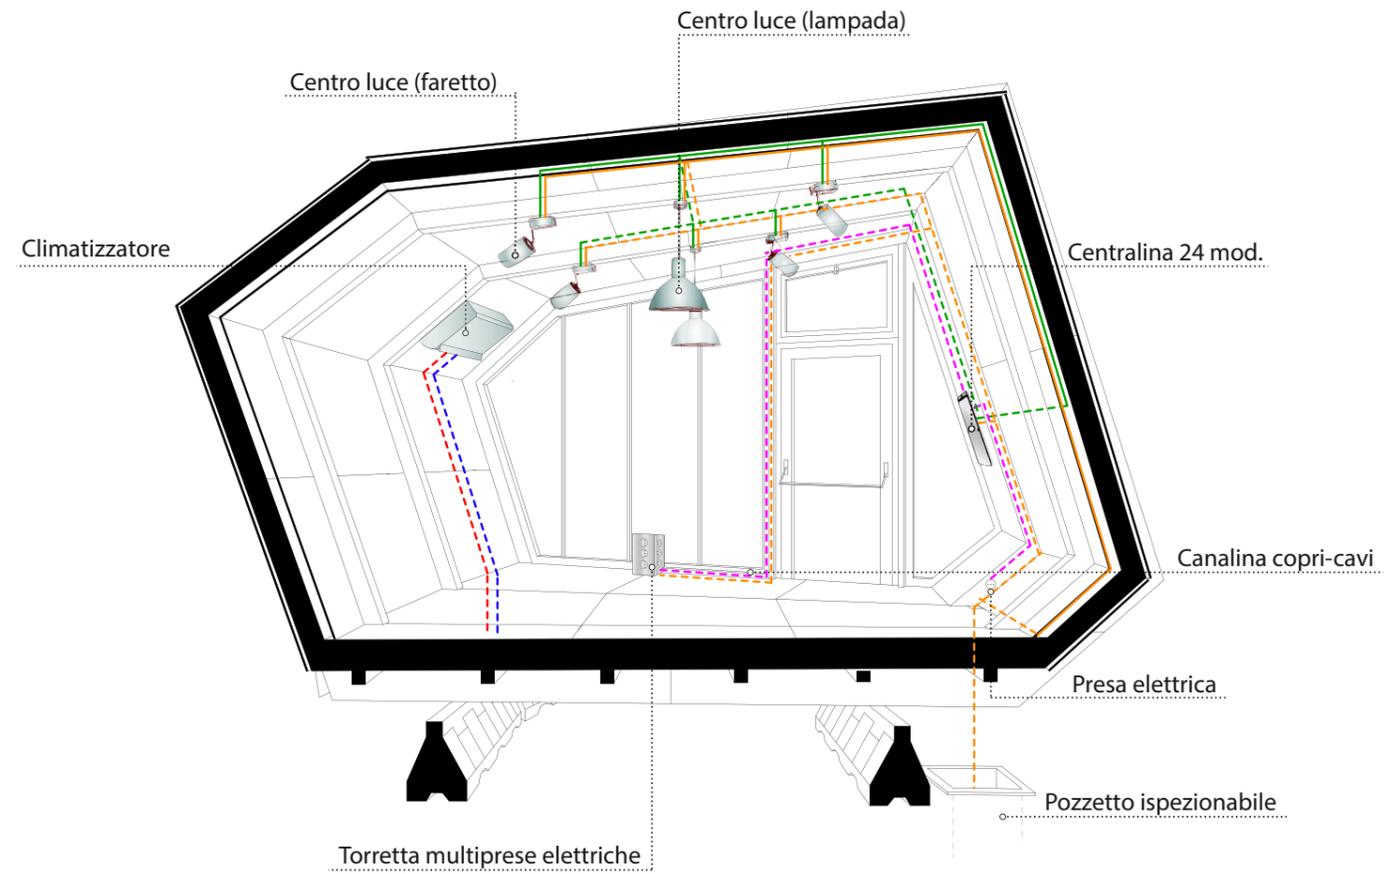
SEZIONE ASSONOMETRICA CON SCHEMA DEGLI IMPIANTI
